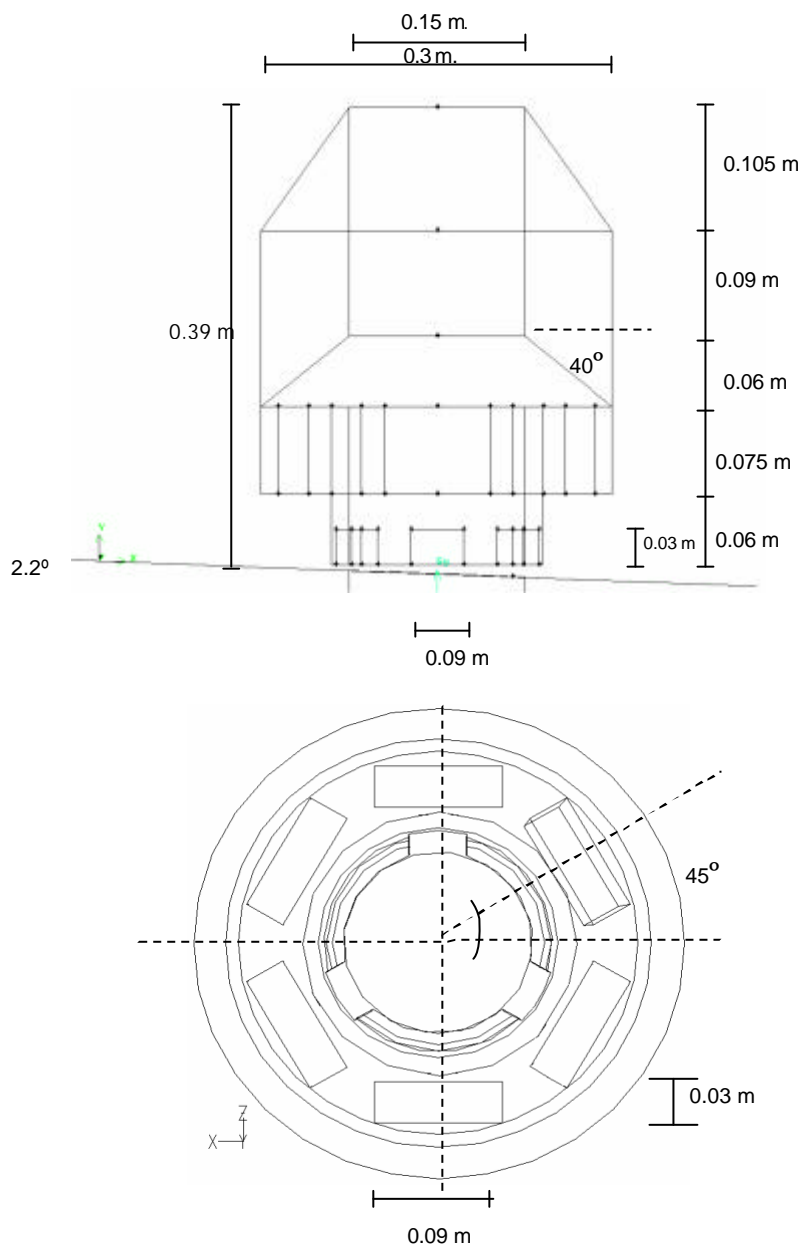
Dimensiones geométricas del VB-2 con forma de ojiva. a).- Vista frontal en 3D y b).- Vista superior.
